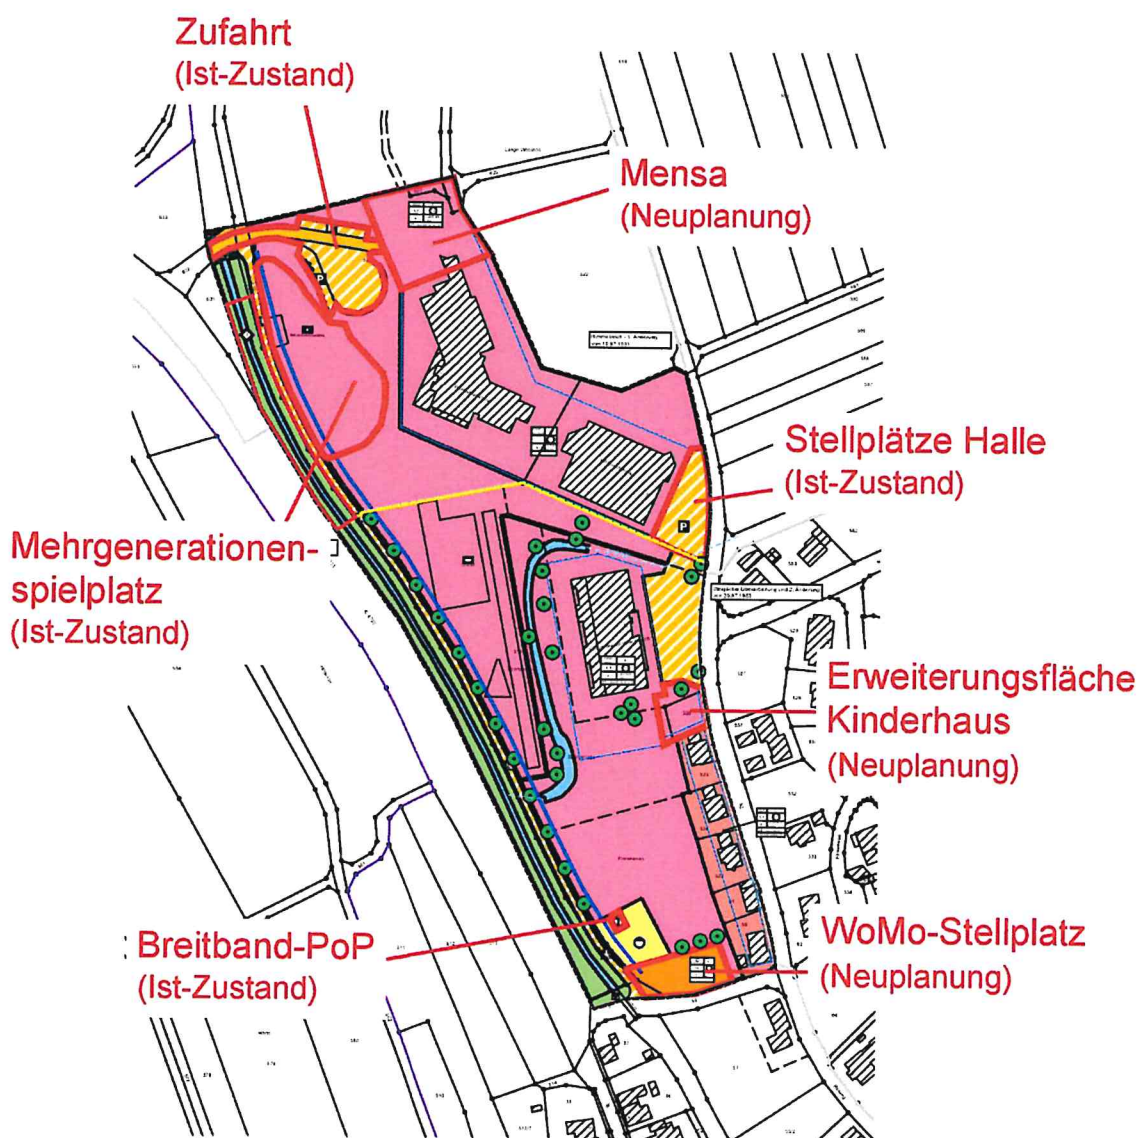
Lageplan Neuplanung mit Änderungen (rot markiert)
